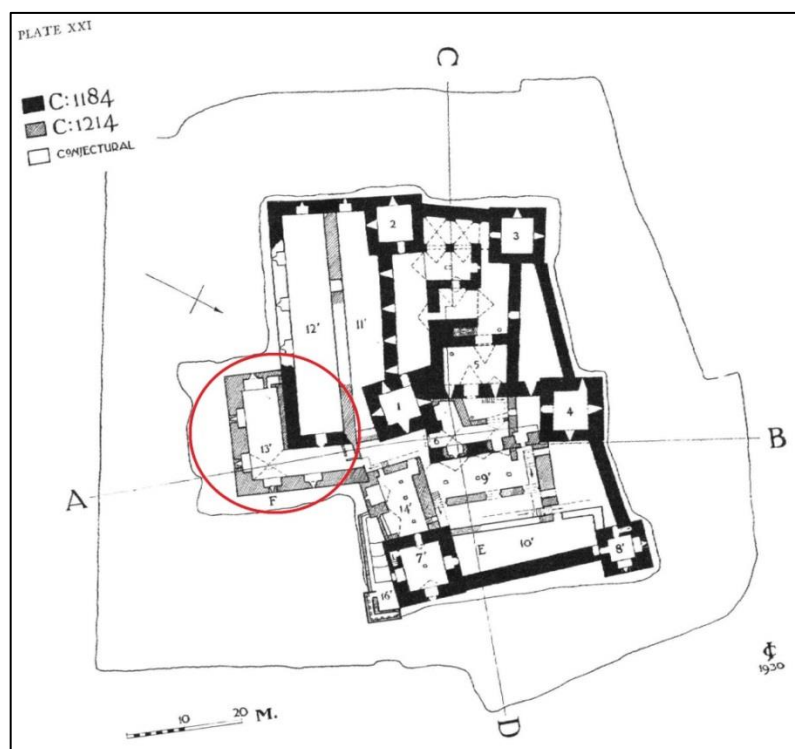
Planimetria del castello di 'Ajlūn (tratto da Johns 1997)
